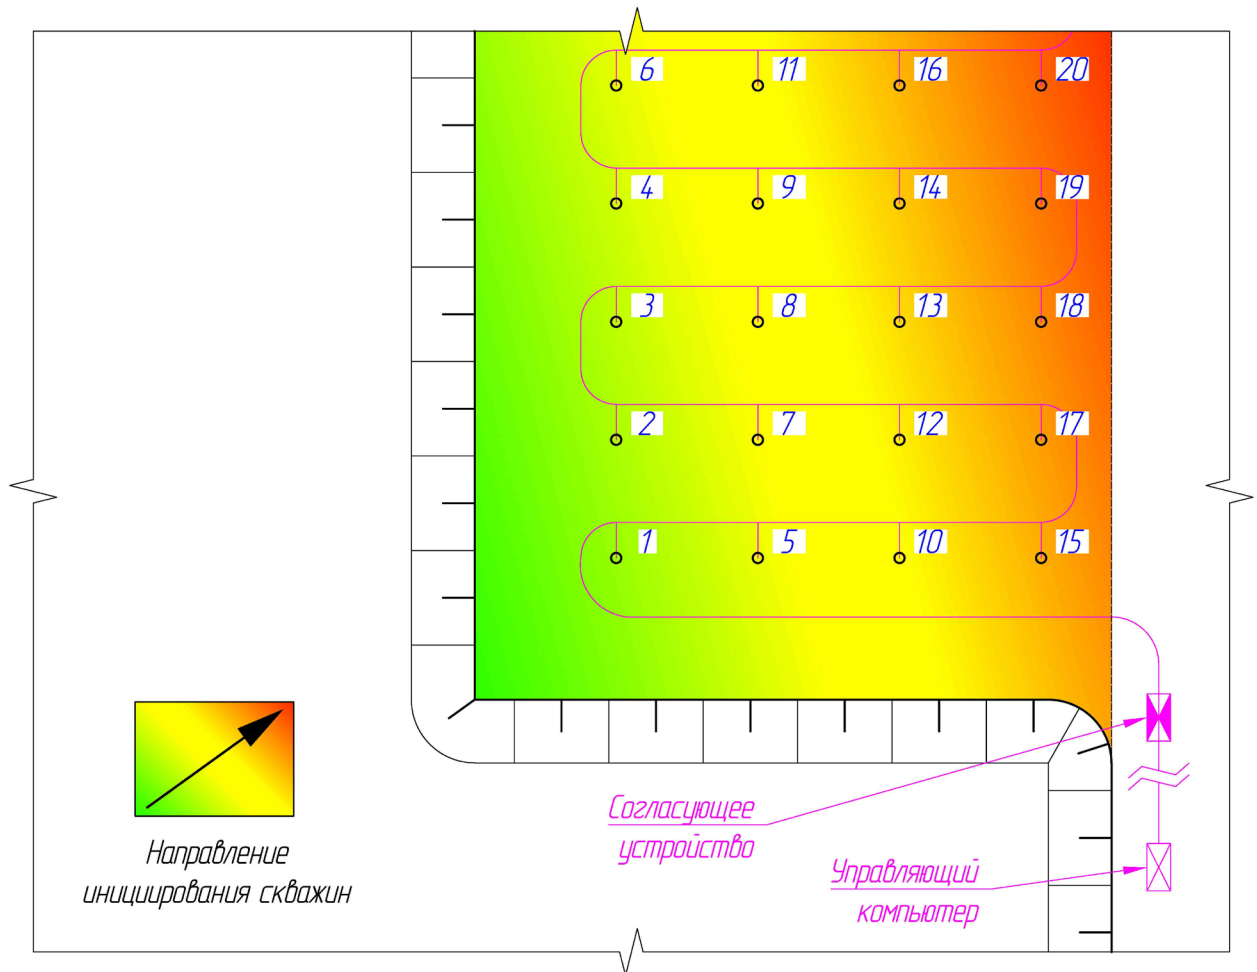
Порядная схема монтажа поверхностной взрывной сети (вариант 3)
